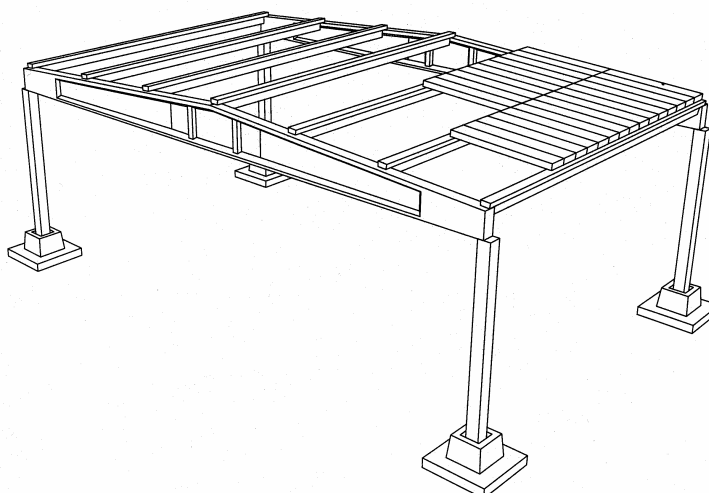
Traves apoiadas com vigas secundárias para cobertura.
